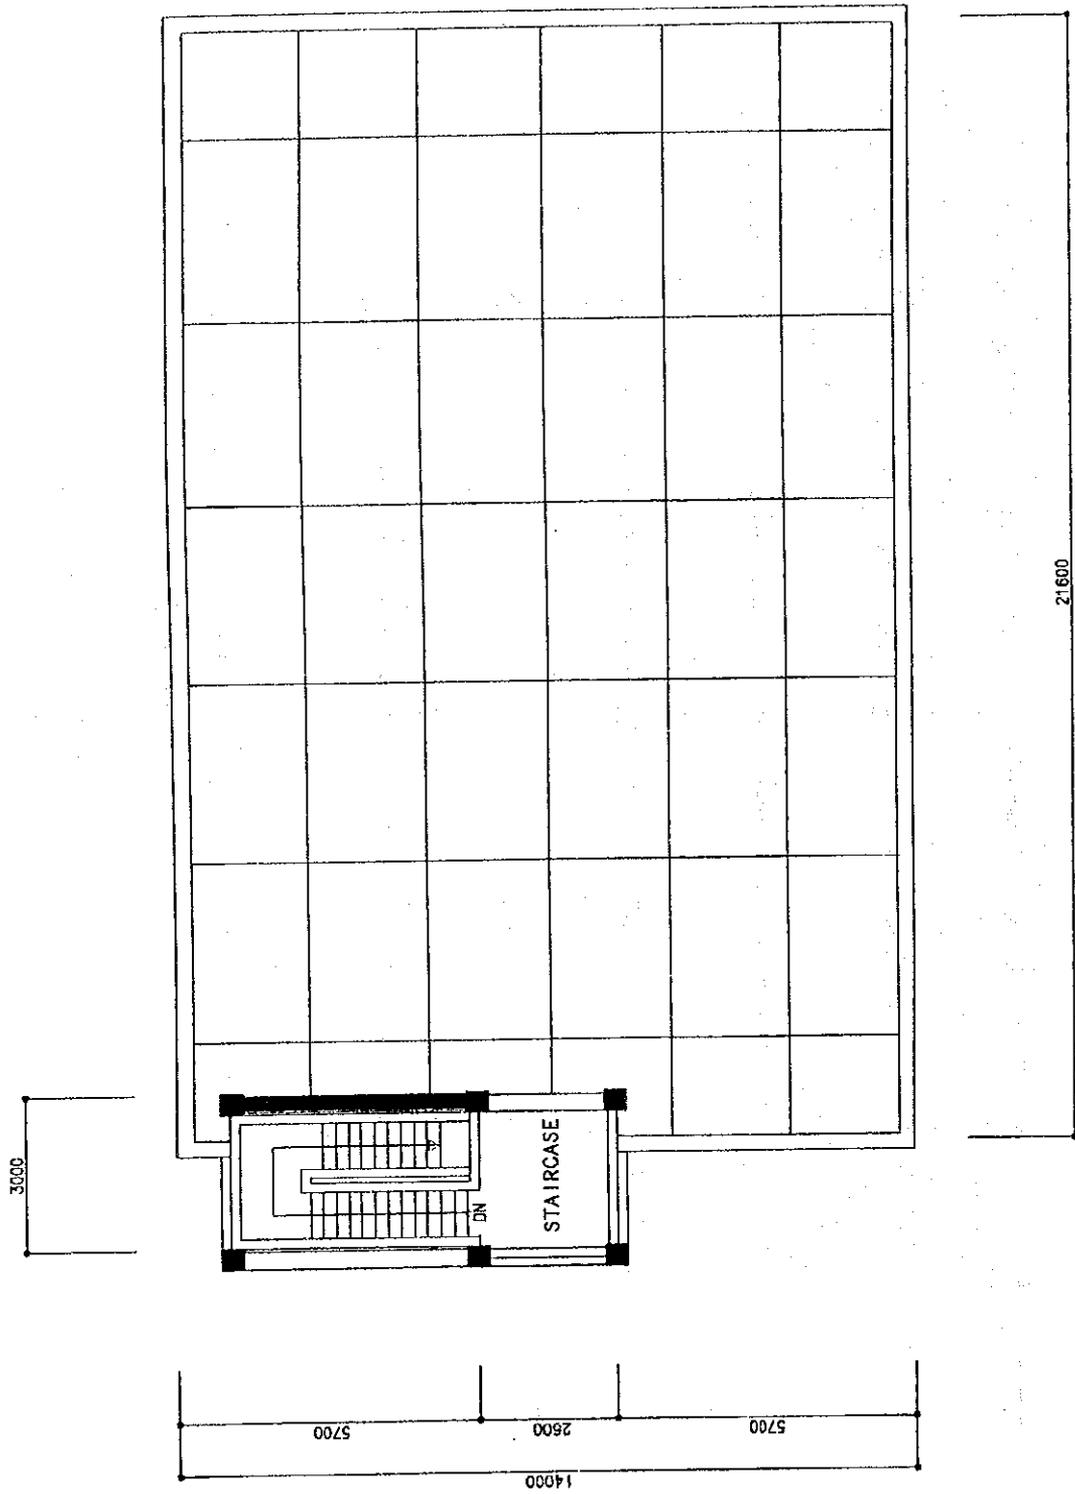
(3) 屋階平面図 (3 教室タイプ)
